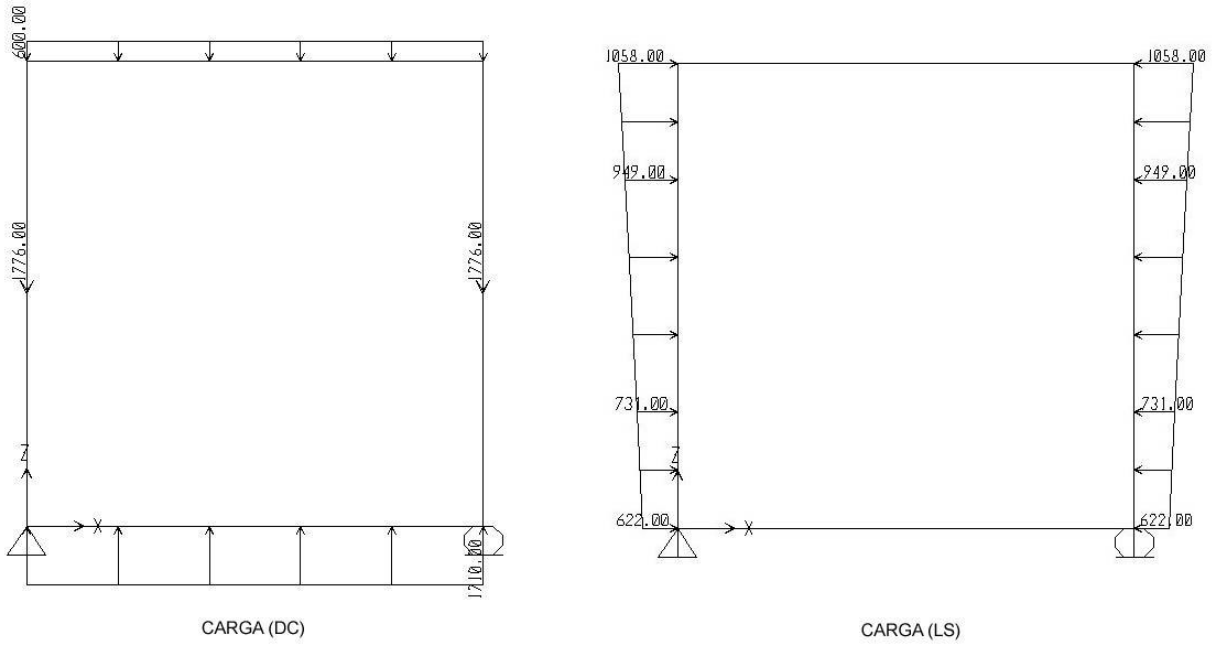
Cargas DC y LS aplicadas en la alcantarilla
